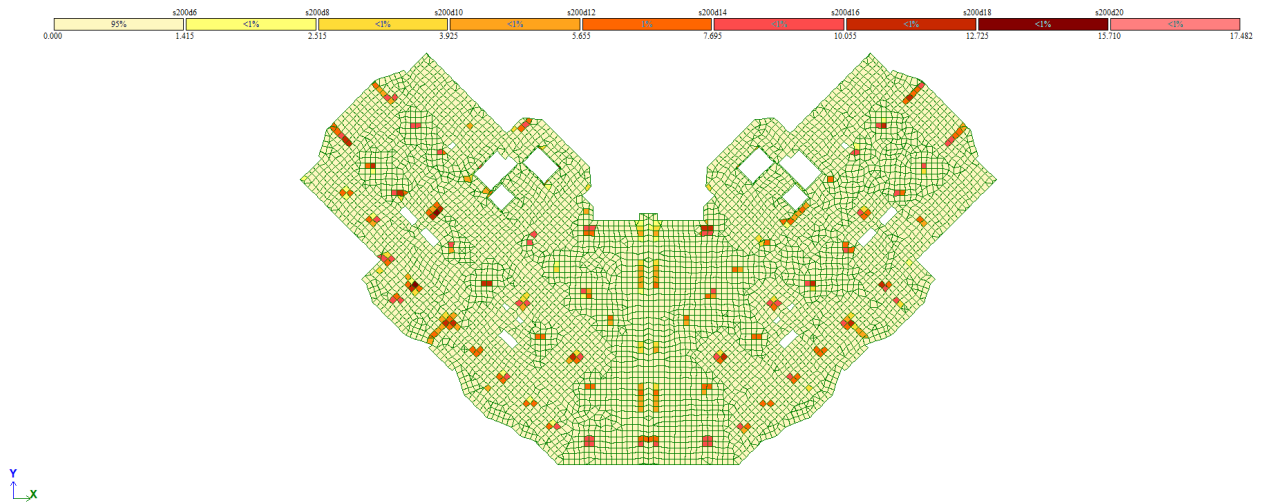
Площа арматури плити на 1 м. п. по осі y (верхня грань)
